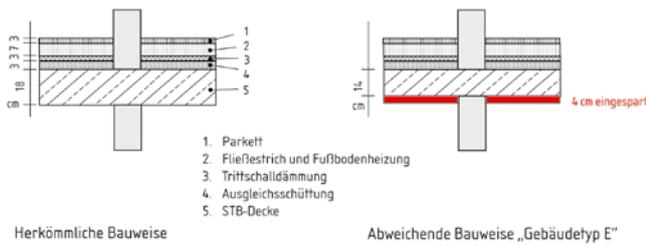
Herkömmliche Bauweise einer Massivbaugeschossdecke (links) und nach Gebäudetyp E abweichende Bauweise einer Massivbaugeschossdecke (rechts), aus [5]
